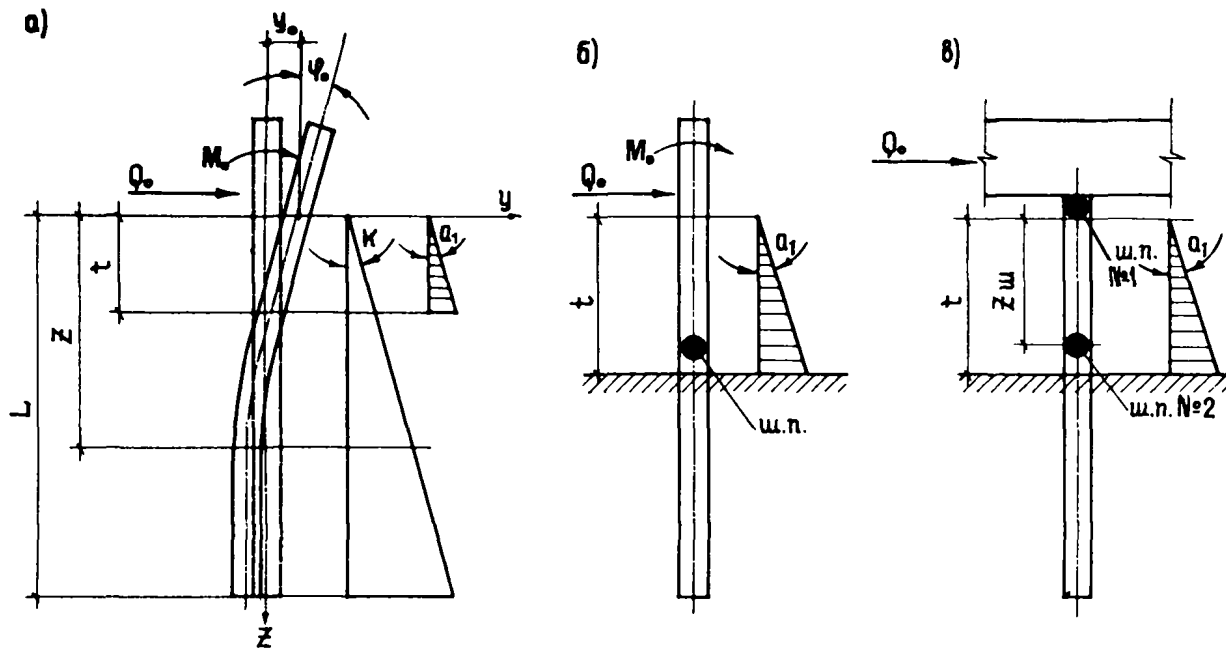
Расчетная схема системы горизонтального нагружения свая-грунт (песчаный грунт)
